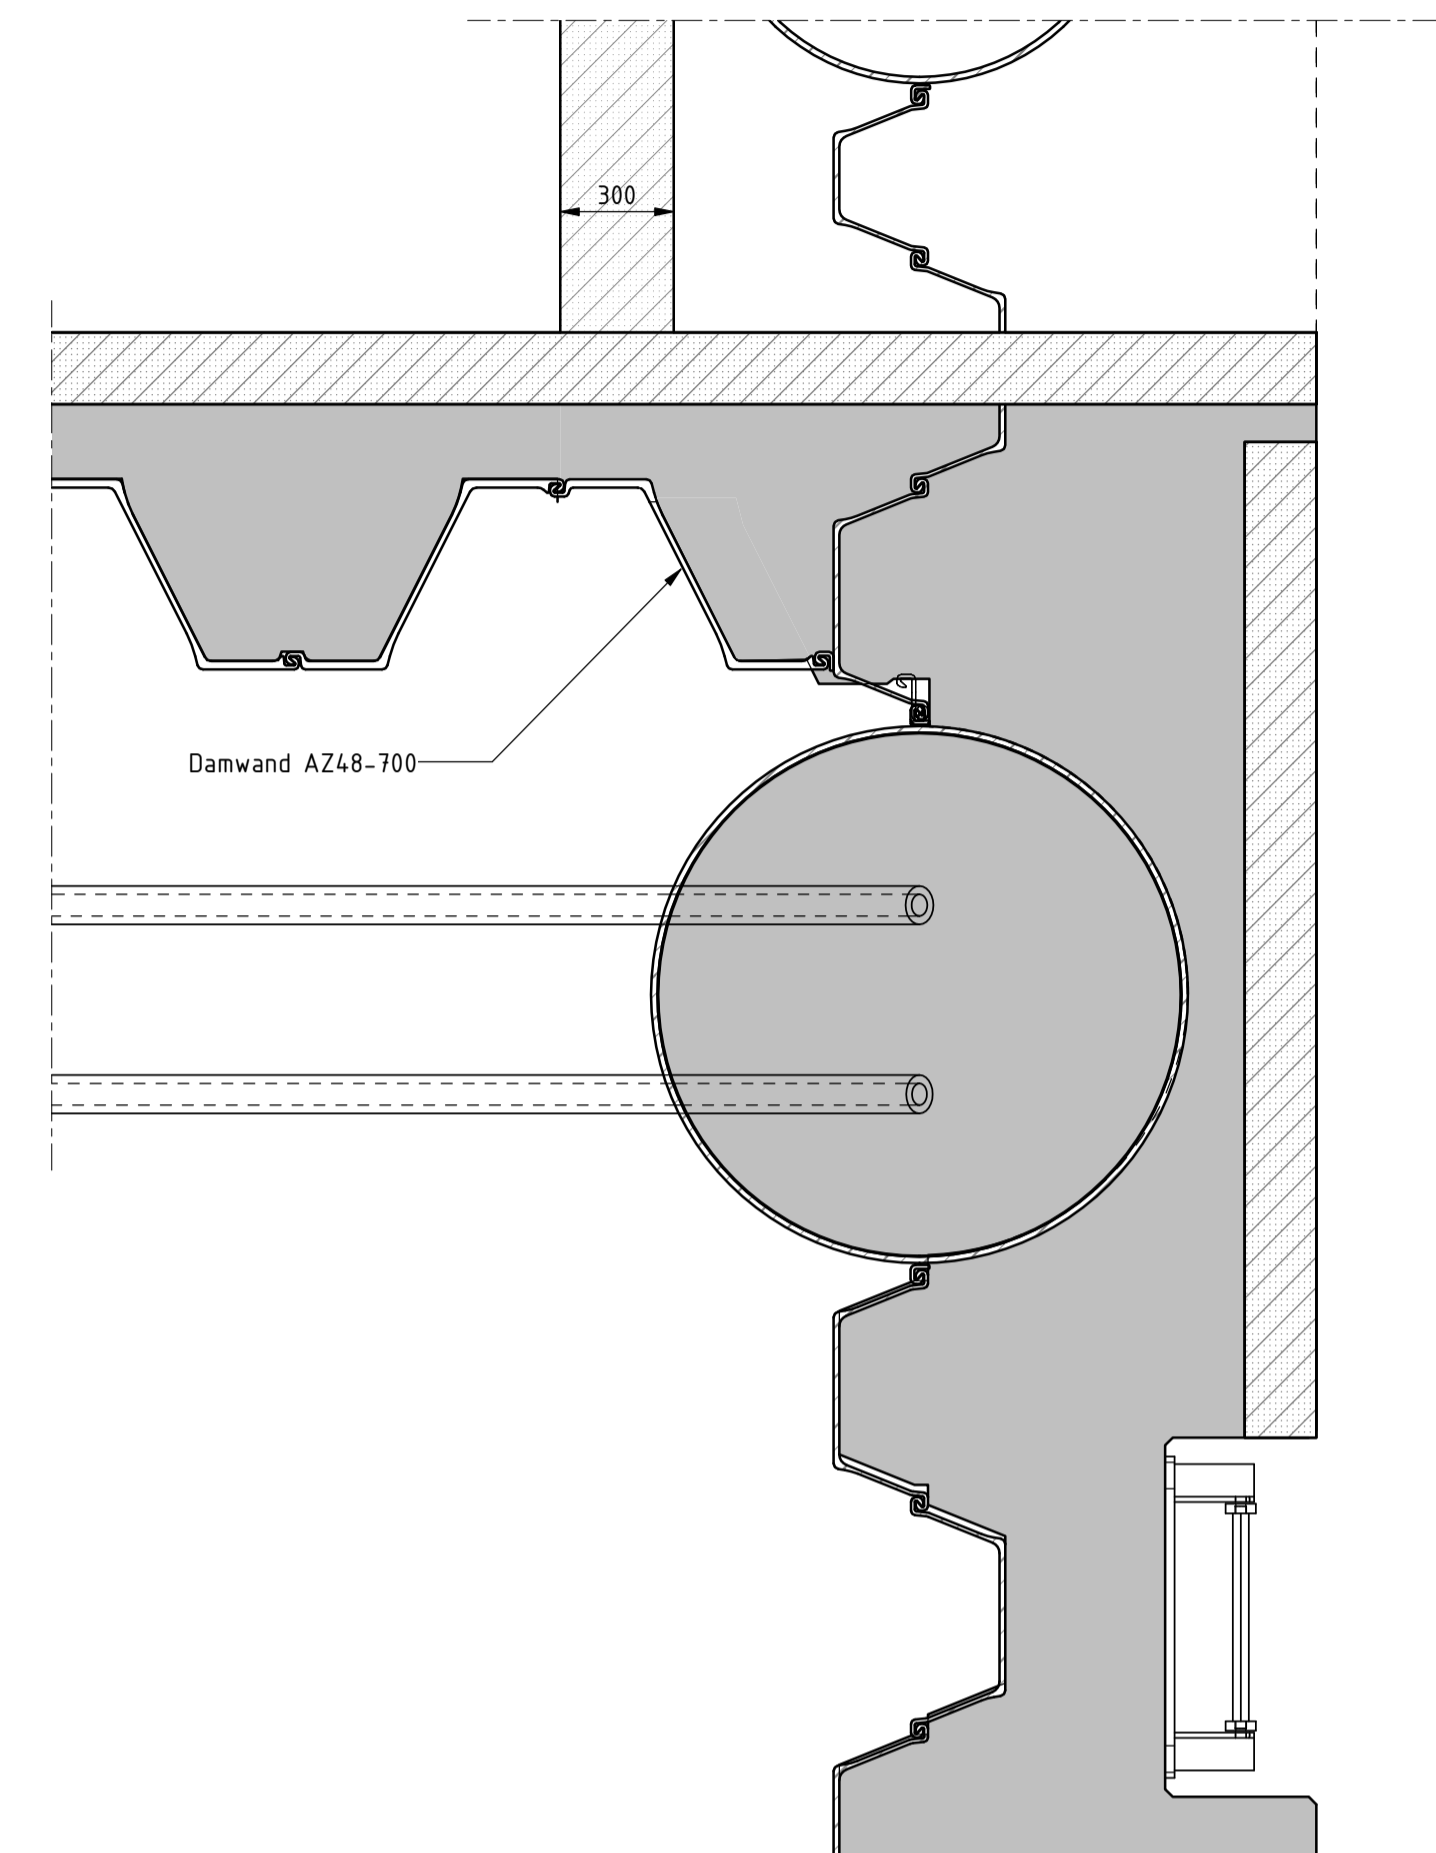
Detail B aansluiting pompwatergebouw +1,2m N.A.P.
